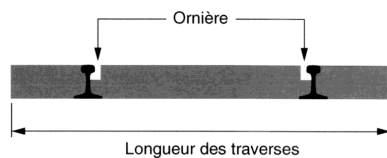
Dimensions de la surface de croisement des passages à niveau - coupe transversale
